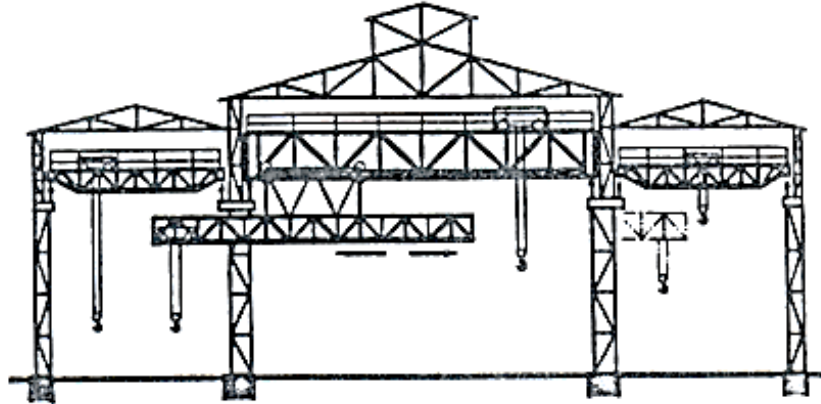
Disposición de Grúa Puente con viga horizontal corrediza.
